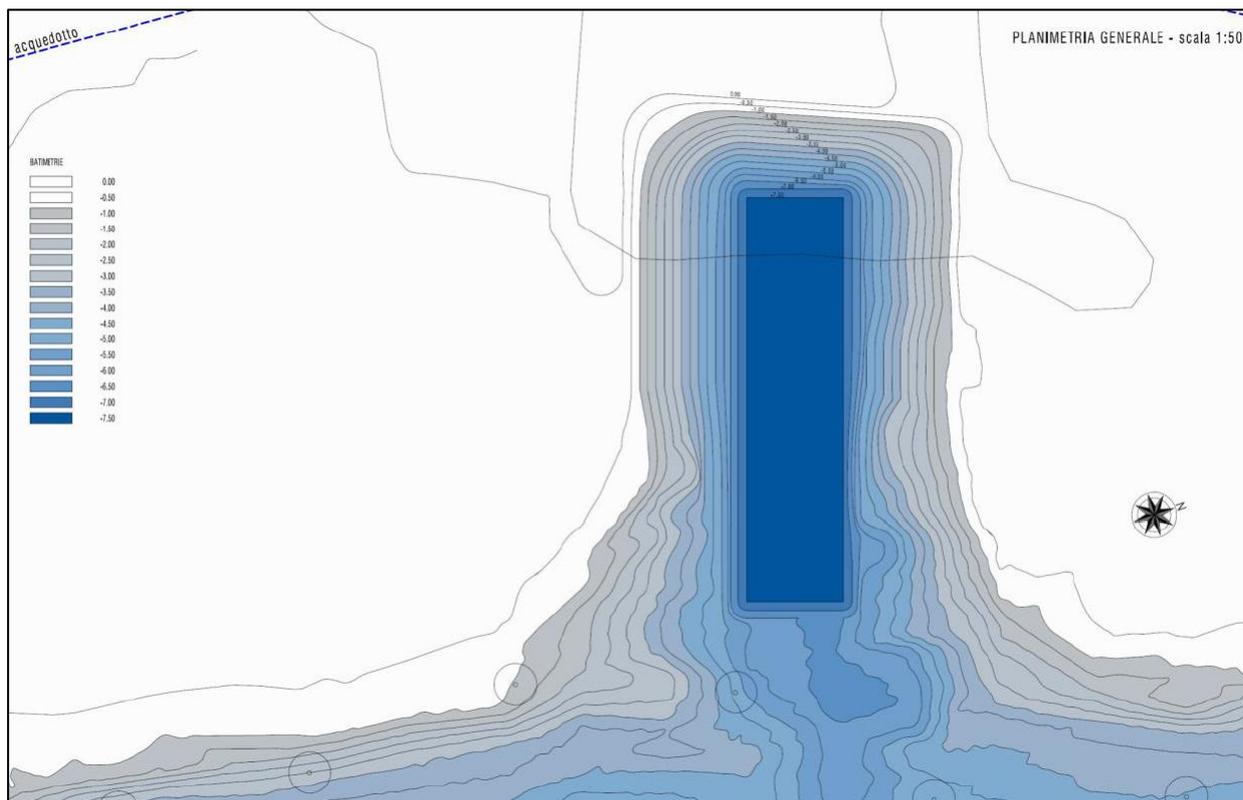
Estratto planimetria di progetto dell'intervento "Adeguamento degli spazi acquei esistenti degli ex Cantieri De Poli"
